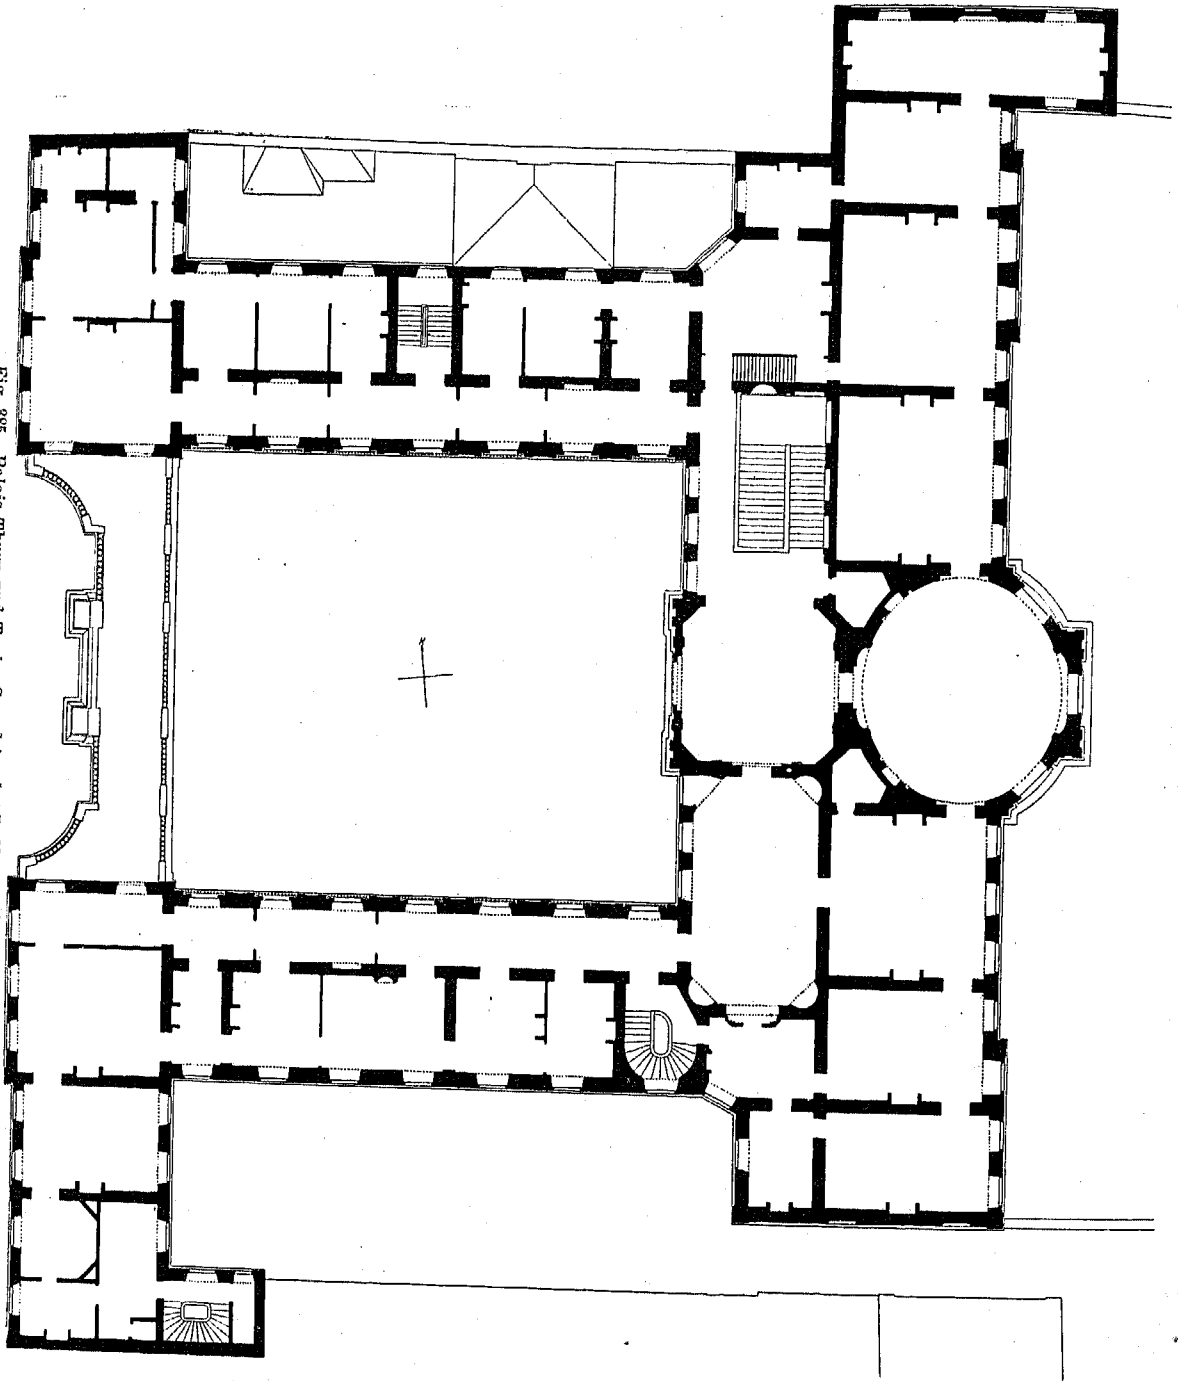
Palais Thurn und Taxis; Grundriss des I. Obergeschosses.
